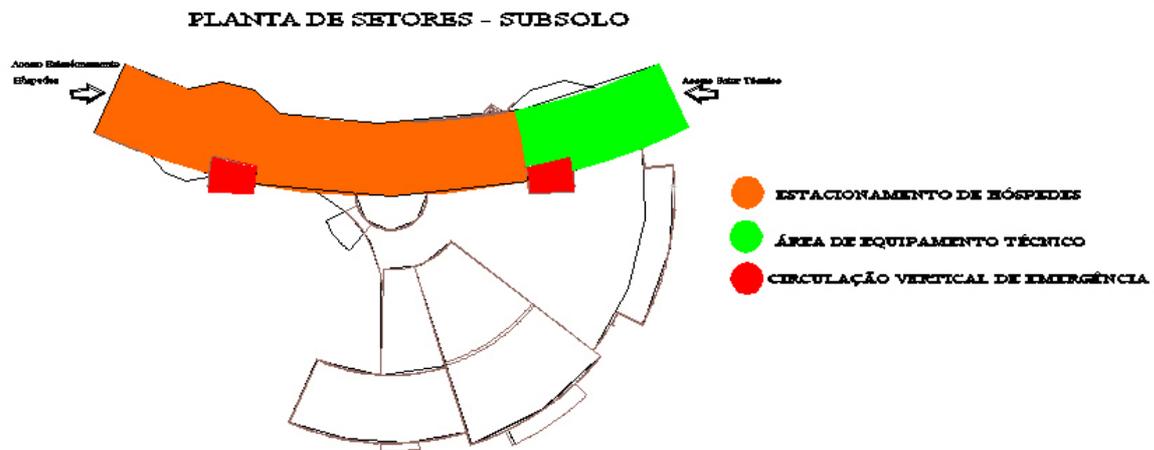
Diagrama – Planta de setores Subsolo. Fonte: LEITE, Leandro S. TFG, UFSM, 2002
